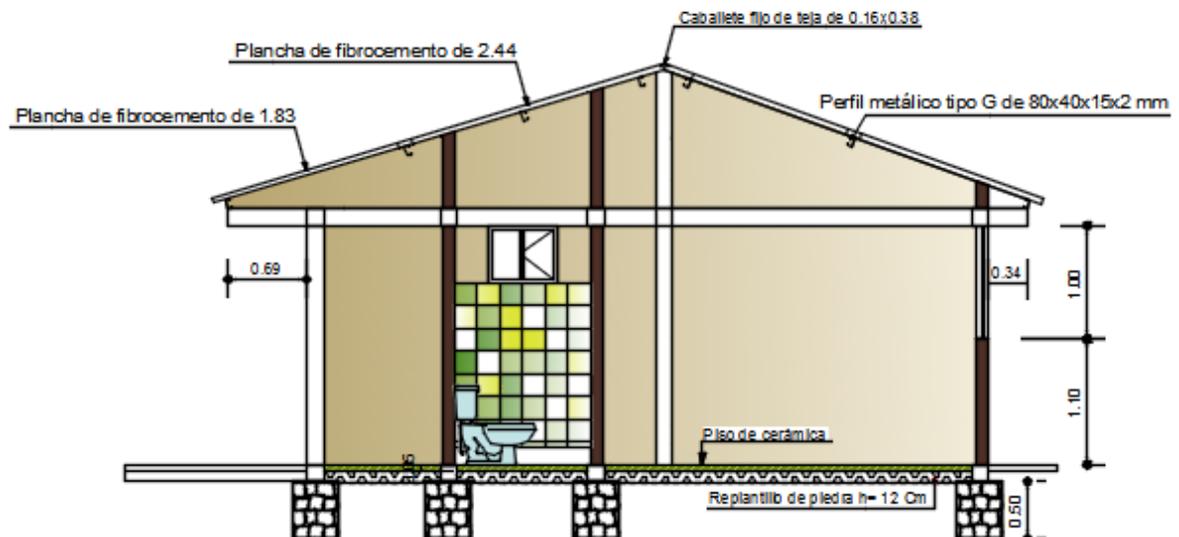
Detalle pórtico vivienda tipo MIDUVI año 2013.
